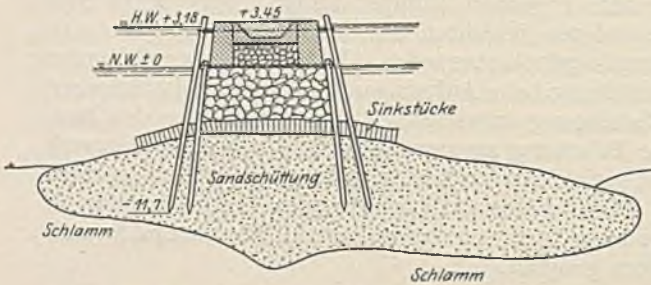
Gründung auf einer verdrängenden Sandschüttung beim Bau einer Mole in Kiel.
